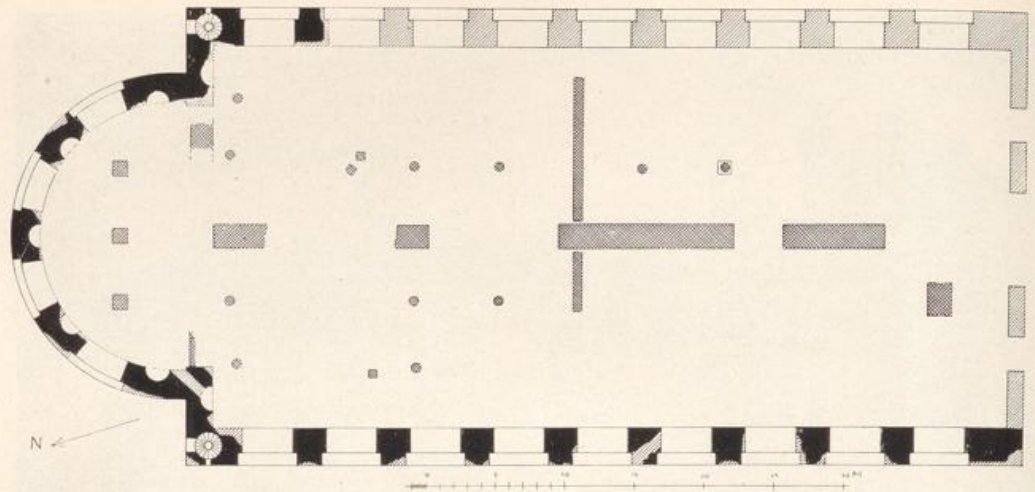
Basilika. Plan mit Eintragung der mittelalterlichen Fundamente (nach Koethe).
